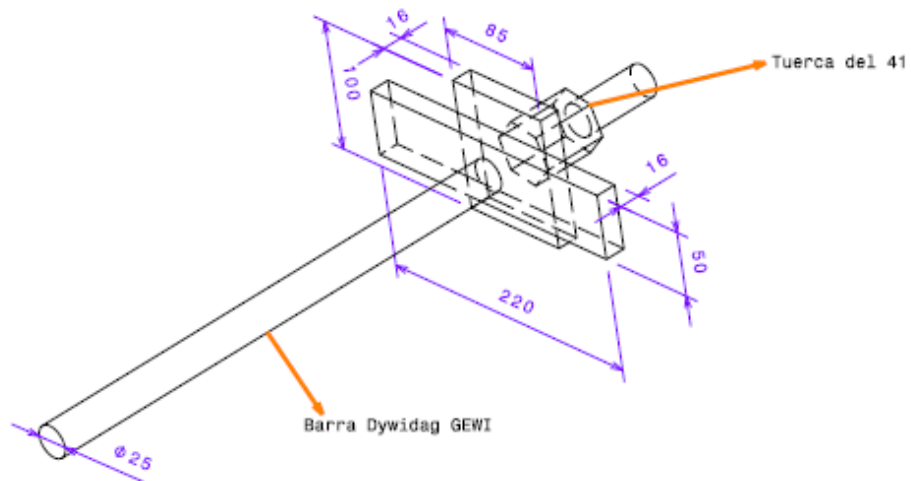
Representación con dimensiones del aparato destinado a transferir las tracciones impuestas en el plano al hormigón
